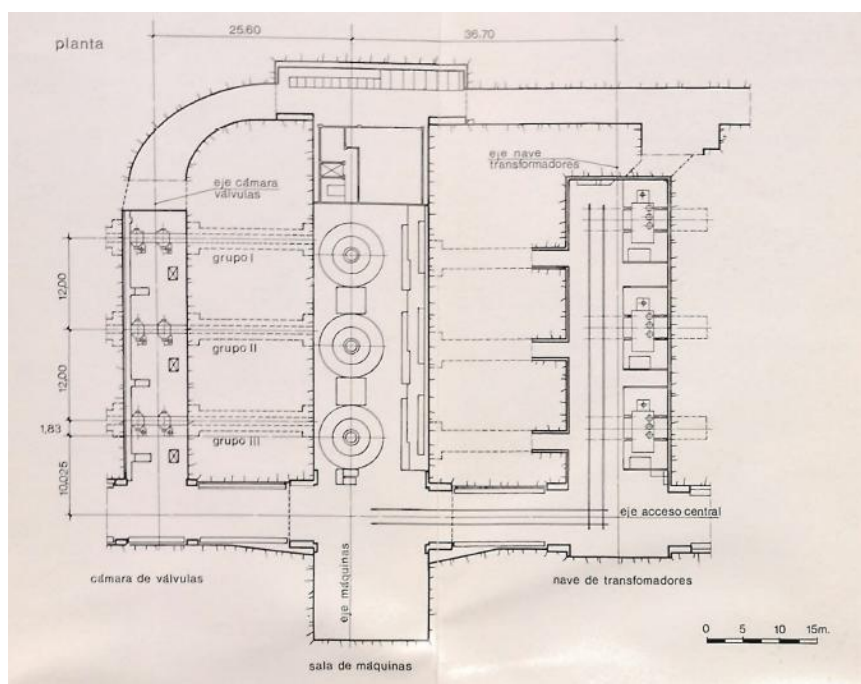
Planta Central Hidroeléctrica Reversible Moralets. Fuente: Fundación Arquia, (s. f.)
